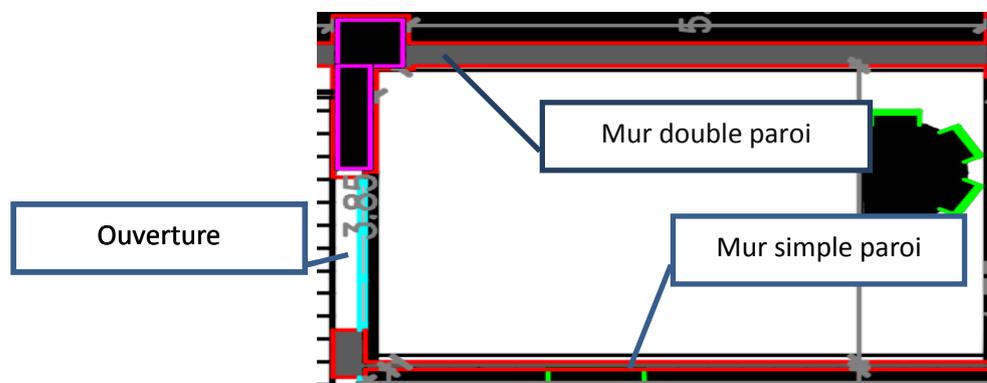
présentation parois double et simple sur le plan d'architecture
